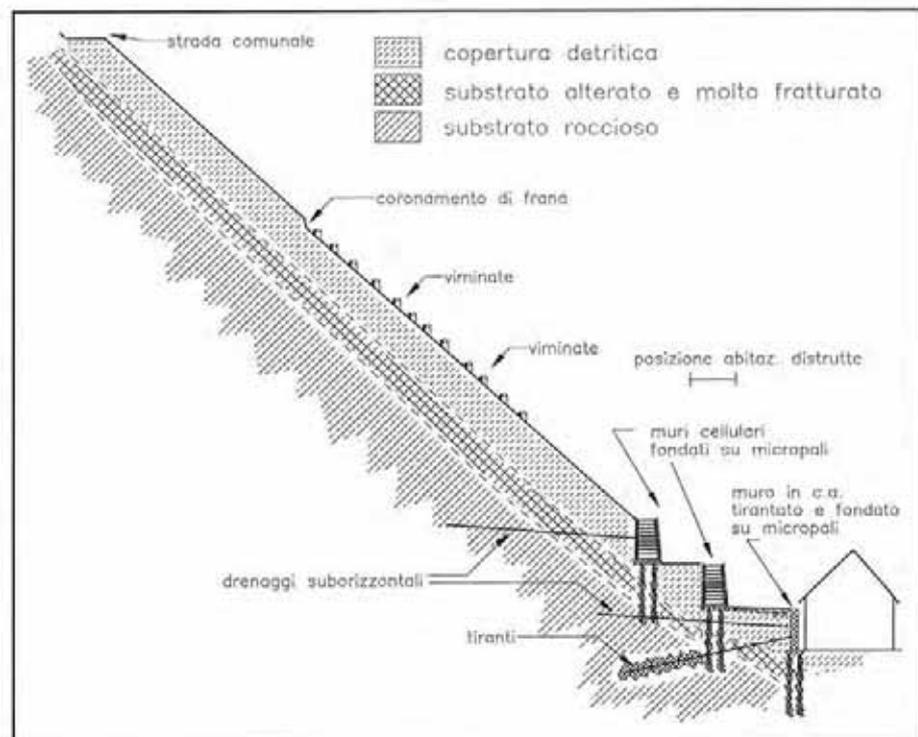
Pessinetto (TO). Sezione schematica del versante interessato dal movimento franoso; sono riportati gli interventi di sistemazione.
